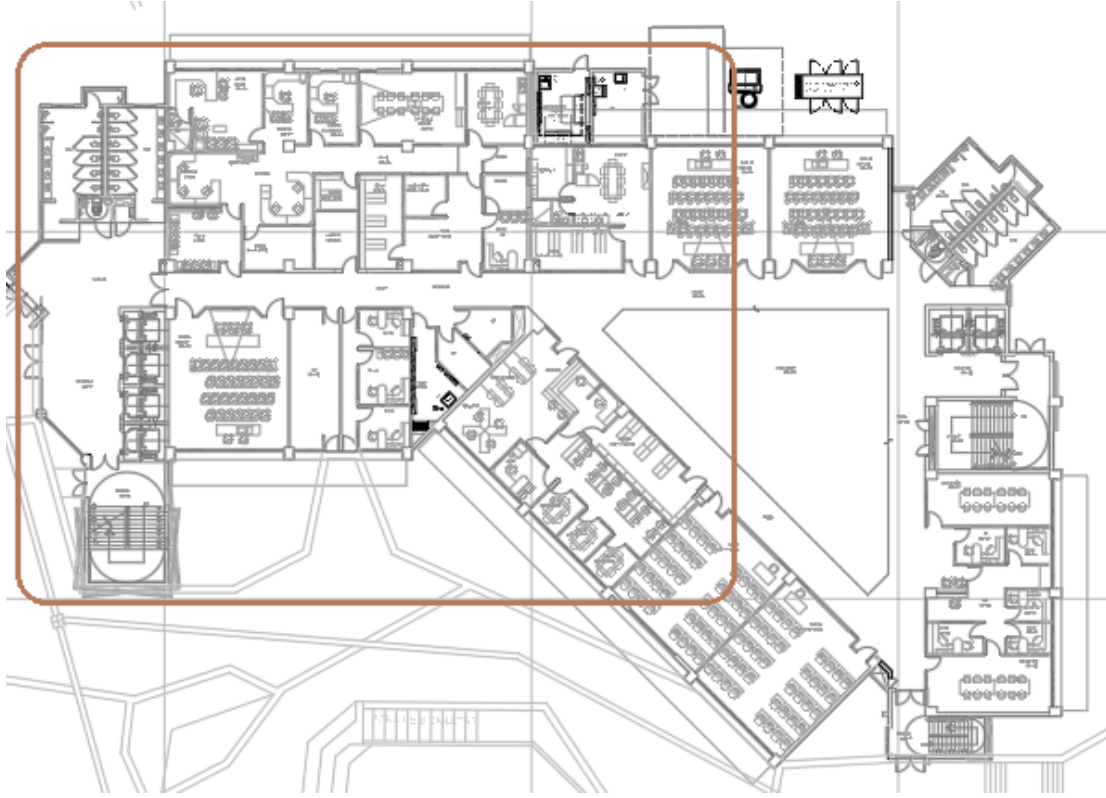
Vista de planta de edificio administrativo, primer nivel, zona de conato y área de modelado (Los Autores, 2018)
